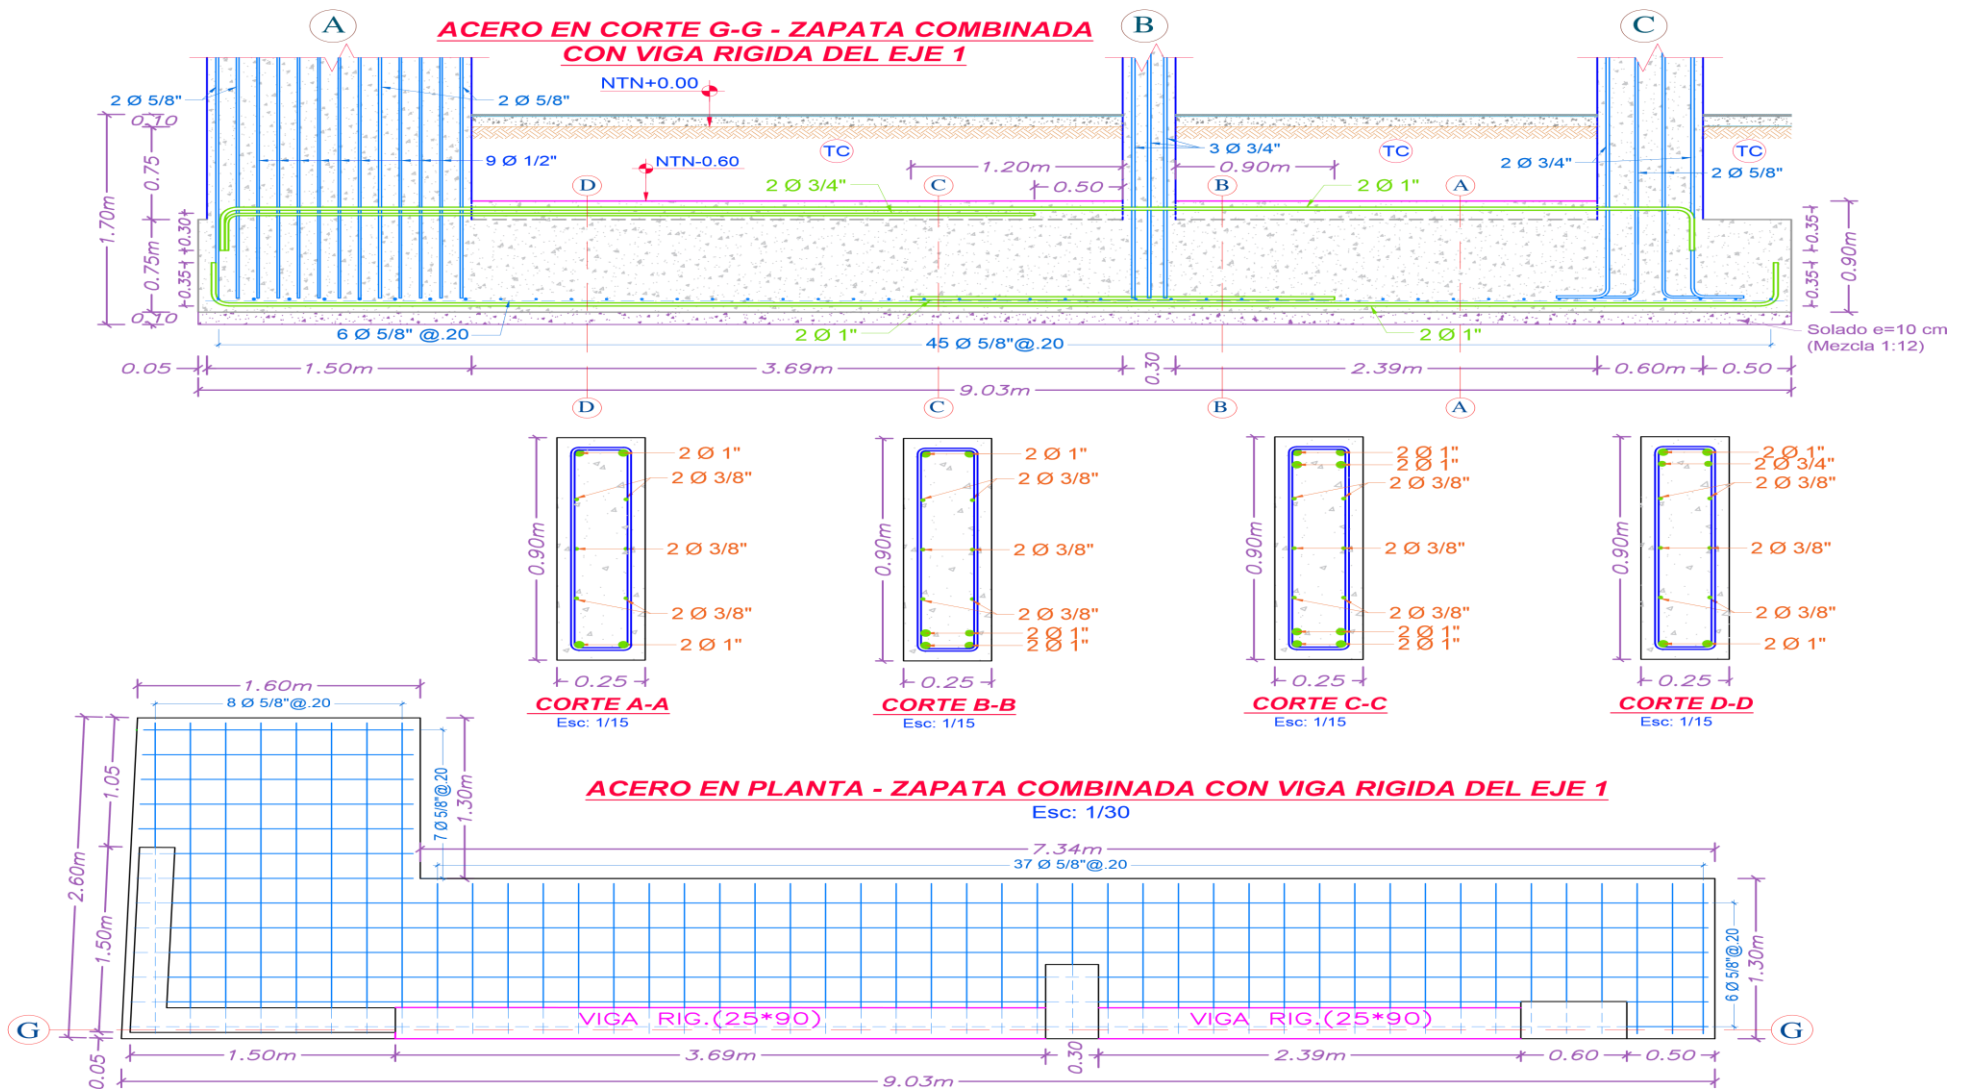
Zapata combinada con viga rigida del eje 1, distribucion de acero longitudinal y transversal.
